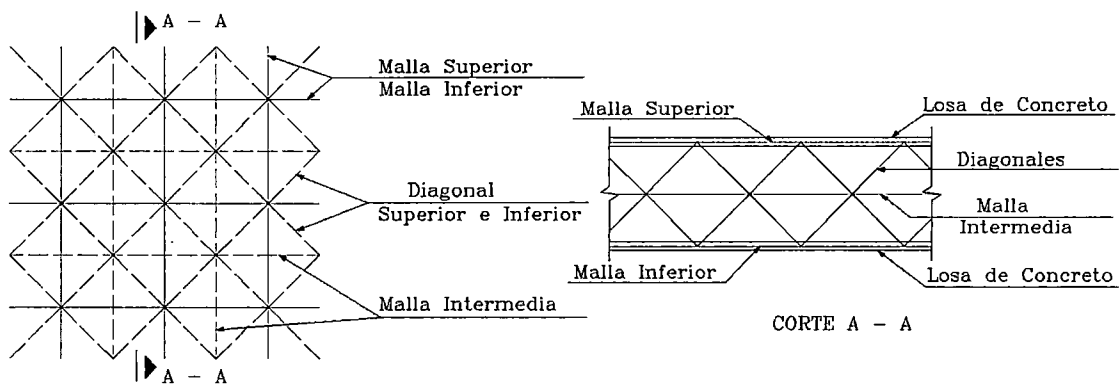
Detalle Típico de Planta de una Tridilosa con Bicelosis.
